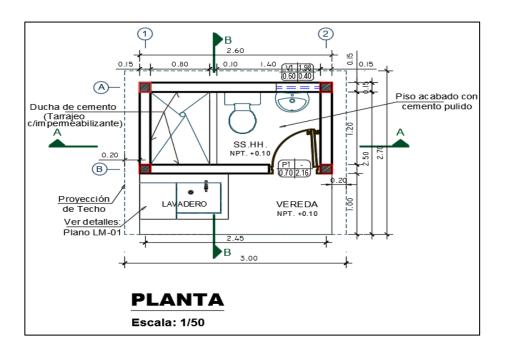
Plano de planta en el cual se diseña a la caseta de la UBS.
